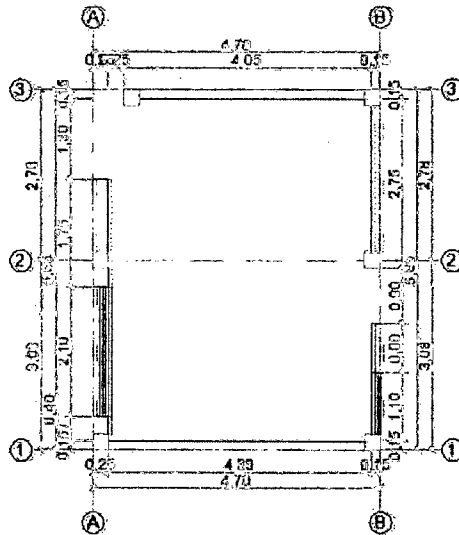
Plano de arquitectura de la planta típica de la Vivienda TV12.
